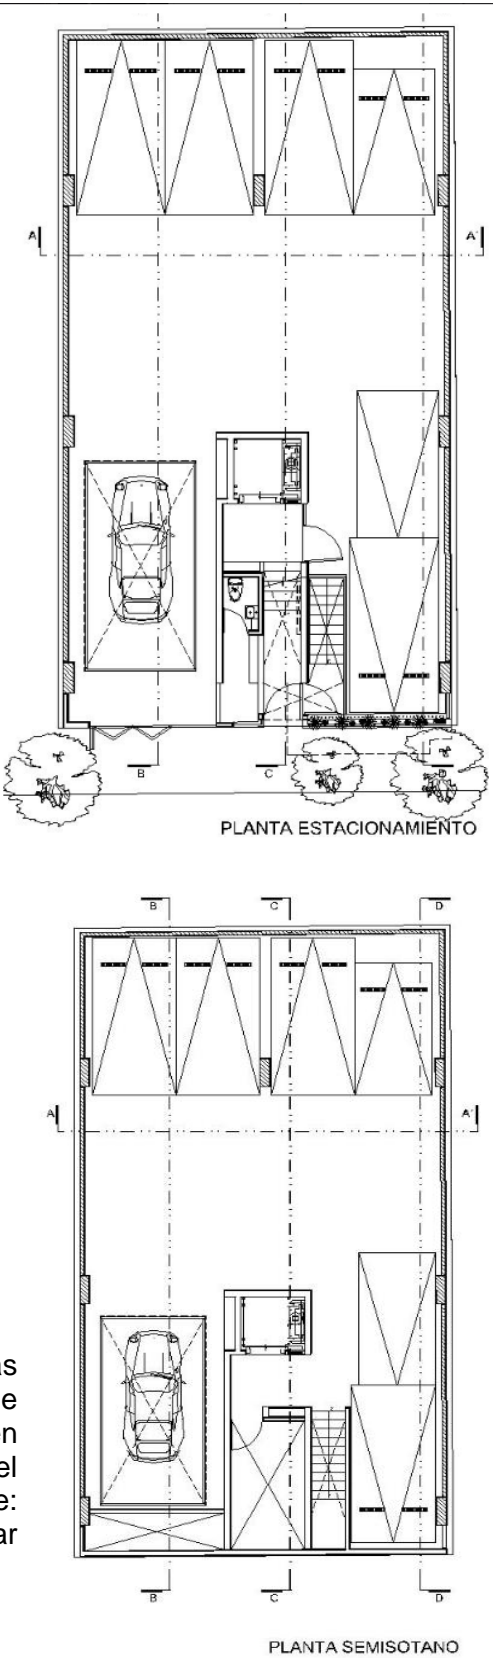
Plantas Arquitectónicas de Estacionamientos en Semisótano y Primer Nivel
